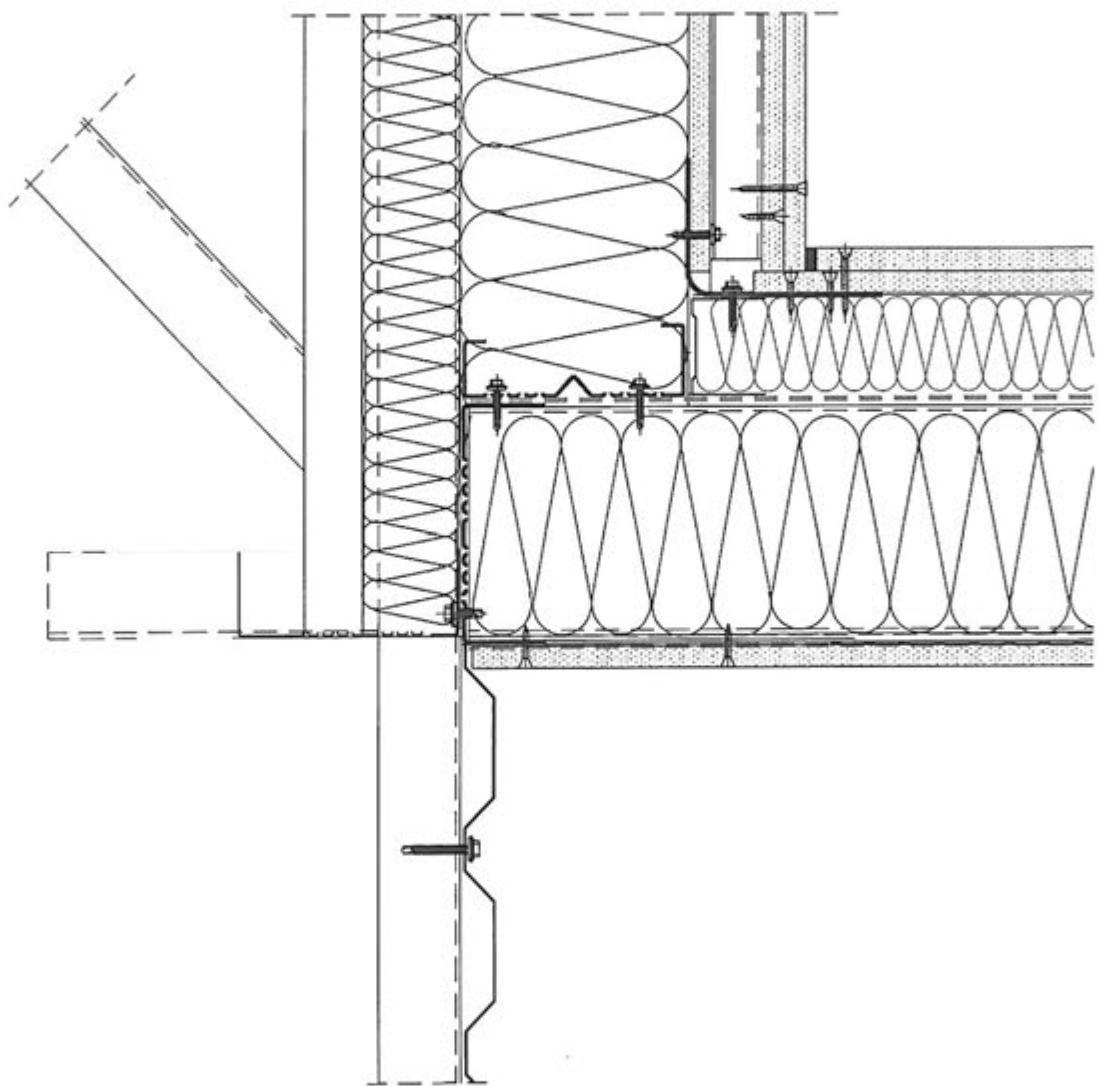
Узел крепления и примыкания конструкции чердачного перекрытия к наружной несущей стене.
